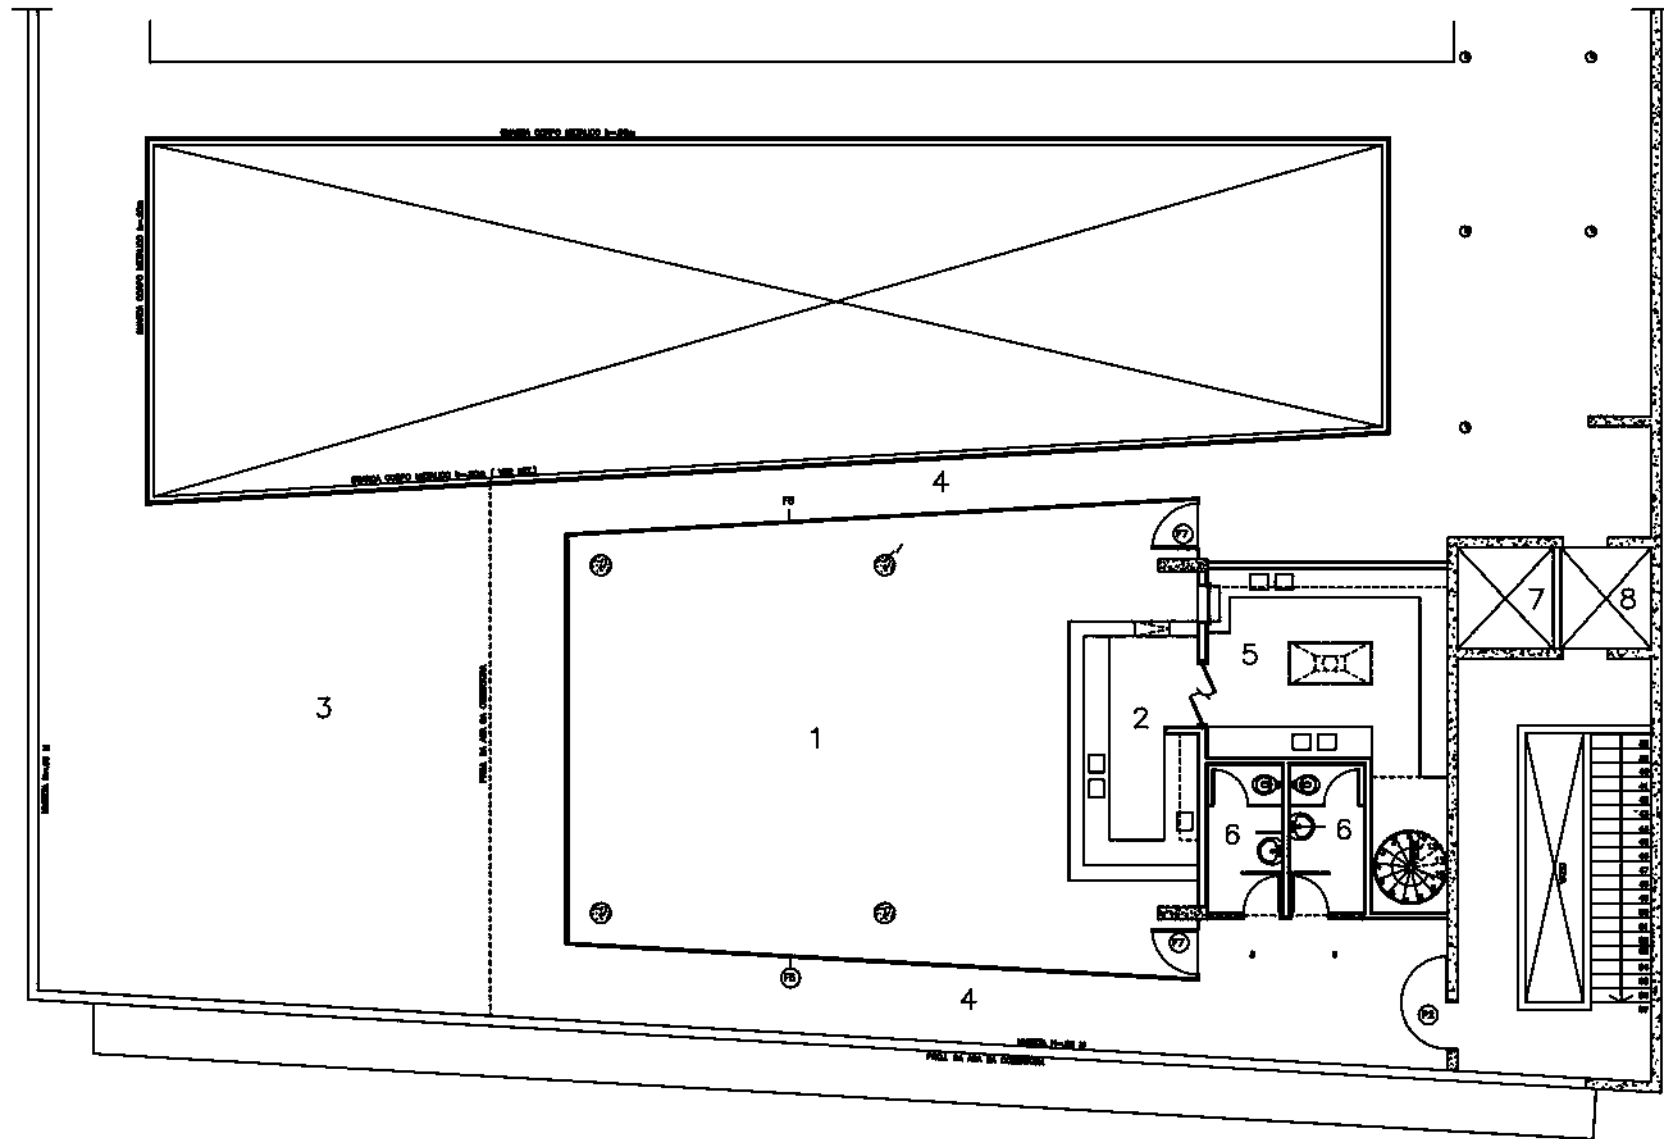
Planta do 3º pavimento do prédio novo (1. restaurante; 2. bar; 3. terraço; 4. circulação; 5. cozinha; 6. sanitários; 7. monta-carga; 8. elevador). Fonte: Acervo Brasil Arquitetura.
